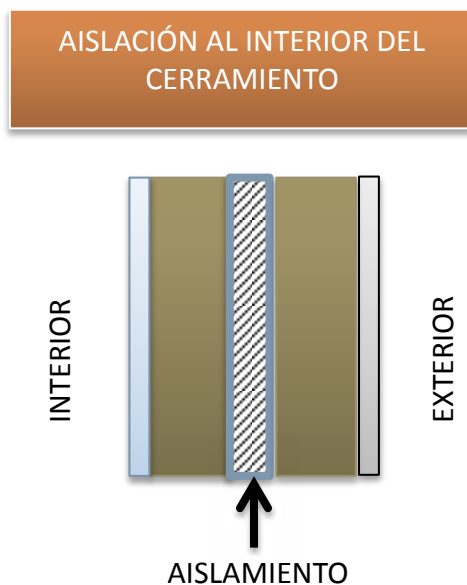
ubicación interna aislamientos en muros Fuente autor
